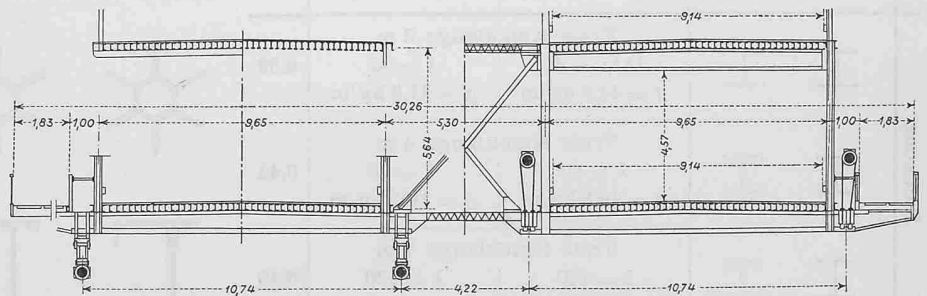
Brooklynbrücke, Projekt für Umbau in Leichtmetall mit zwölf Fahrbahnstreifen in zwei Stockwerken; Masstab 1:250
